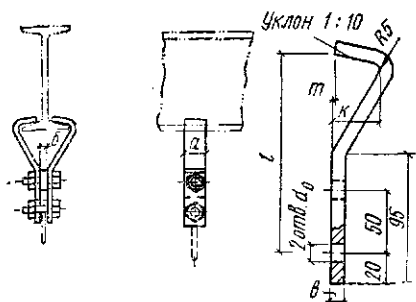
Хомутки для крепления полиэтиленовых труб D_y 100 мм к закладным деталям сваркой в санитарно-технических кабинках
